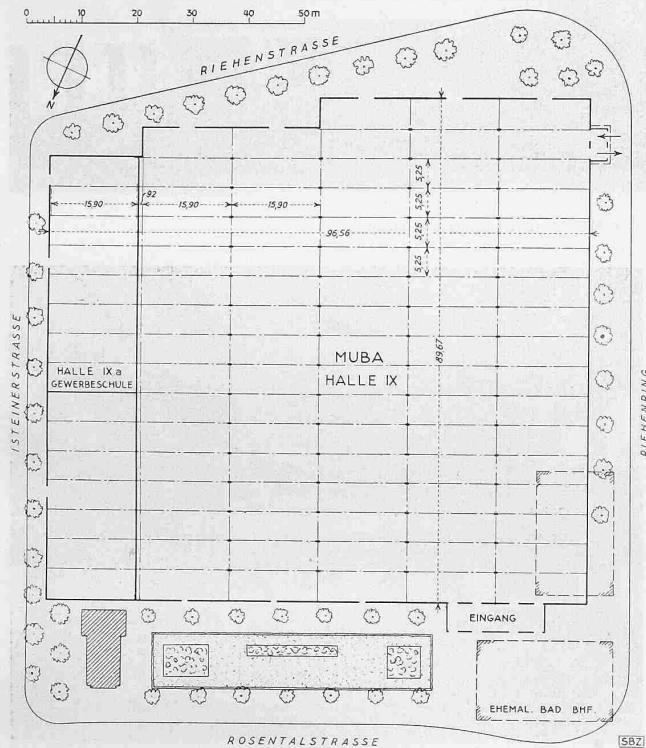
Grundriss der Mustermess-Halle IX. — 1:1200
